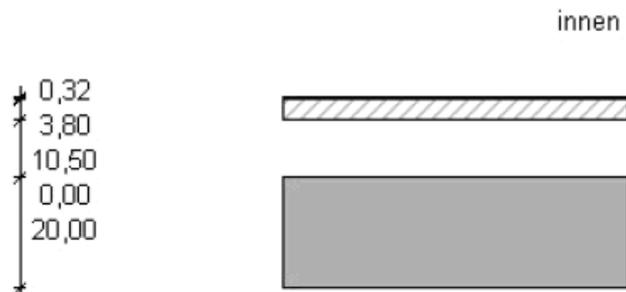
Schemaschnitt Stahlbetondecke und Fußbodenaufbau
